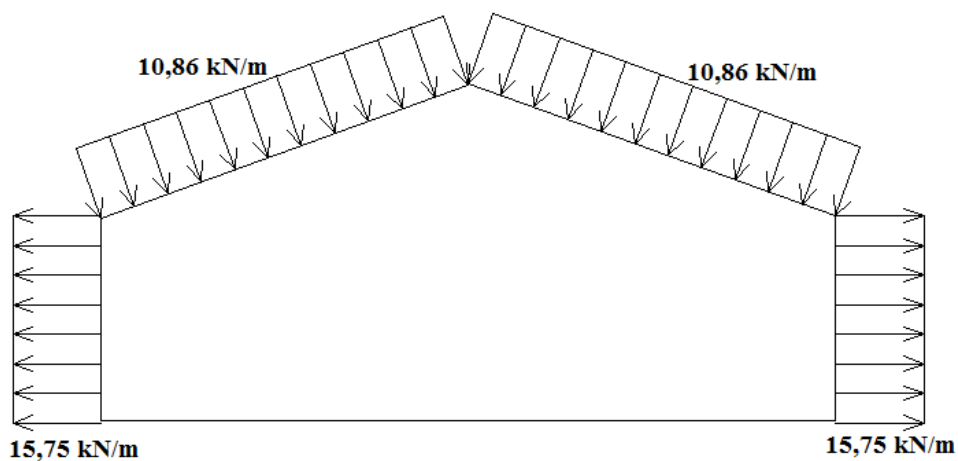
24. Acciones más desfavorables que se dan en el pórtico 1.
